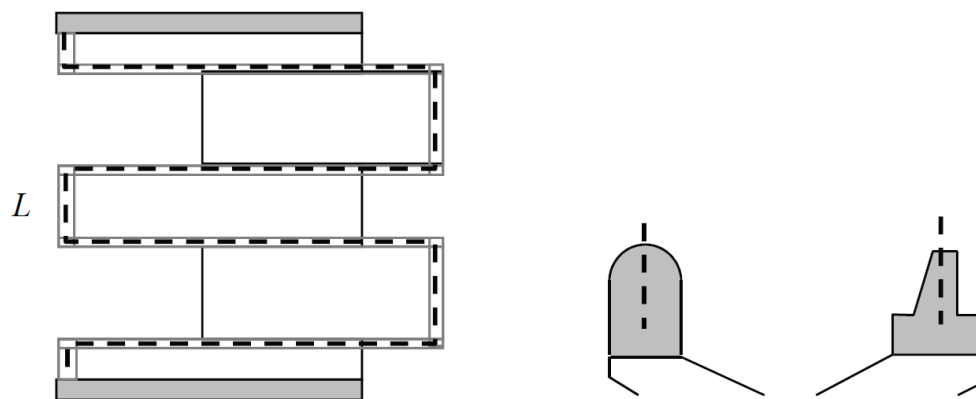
Longitud de cresta desarrollada y secciones transversales típicas
